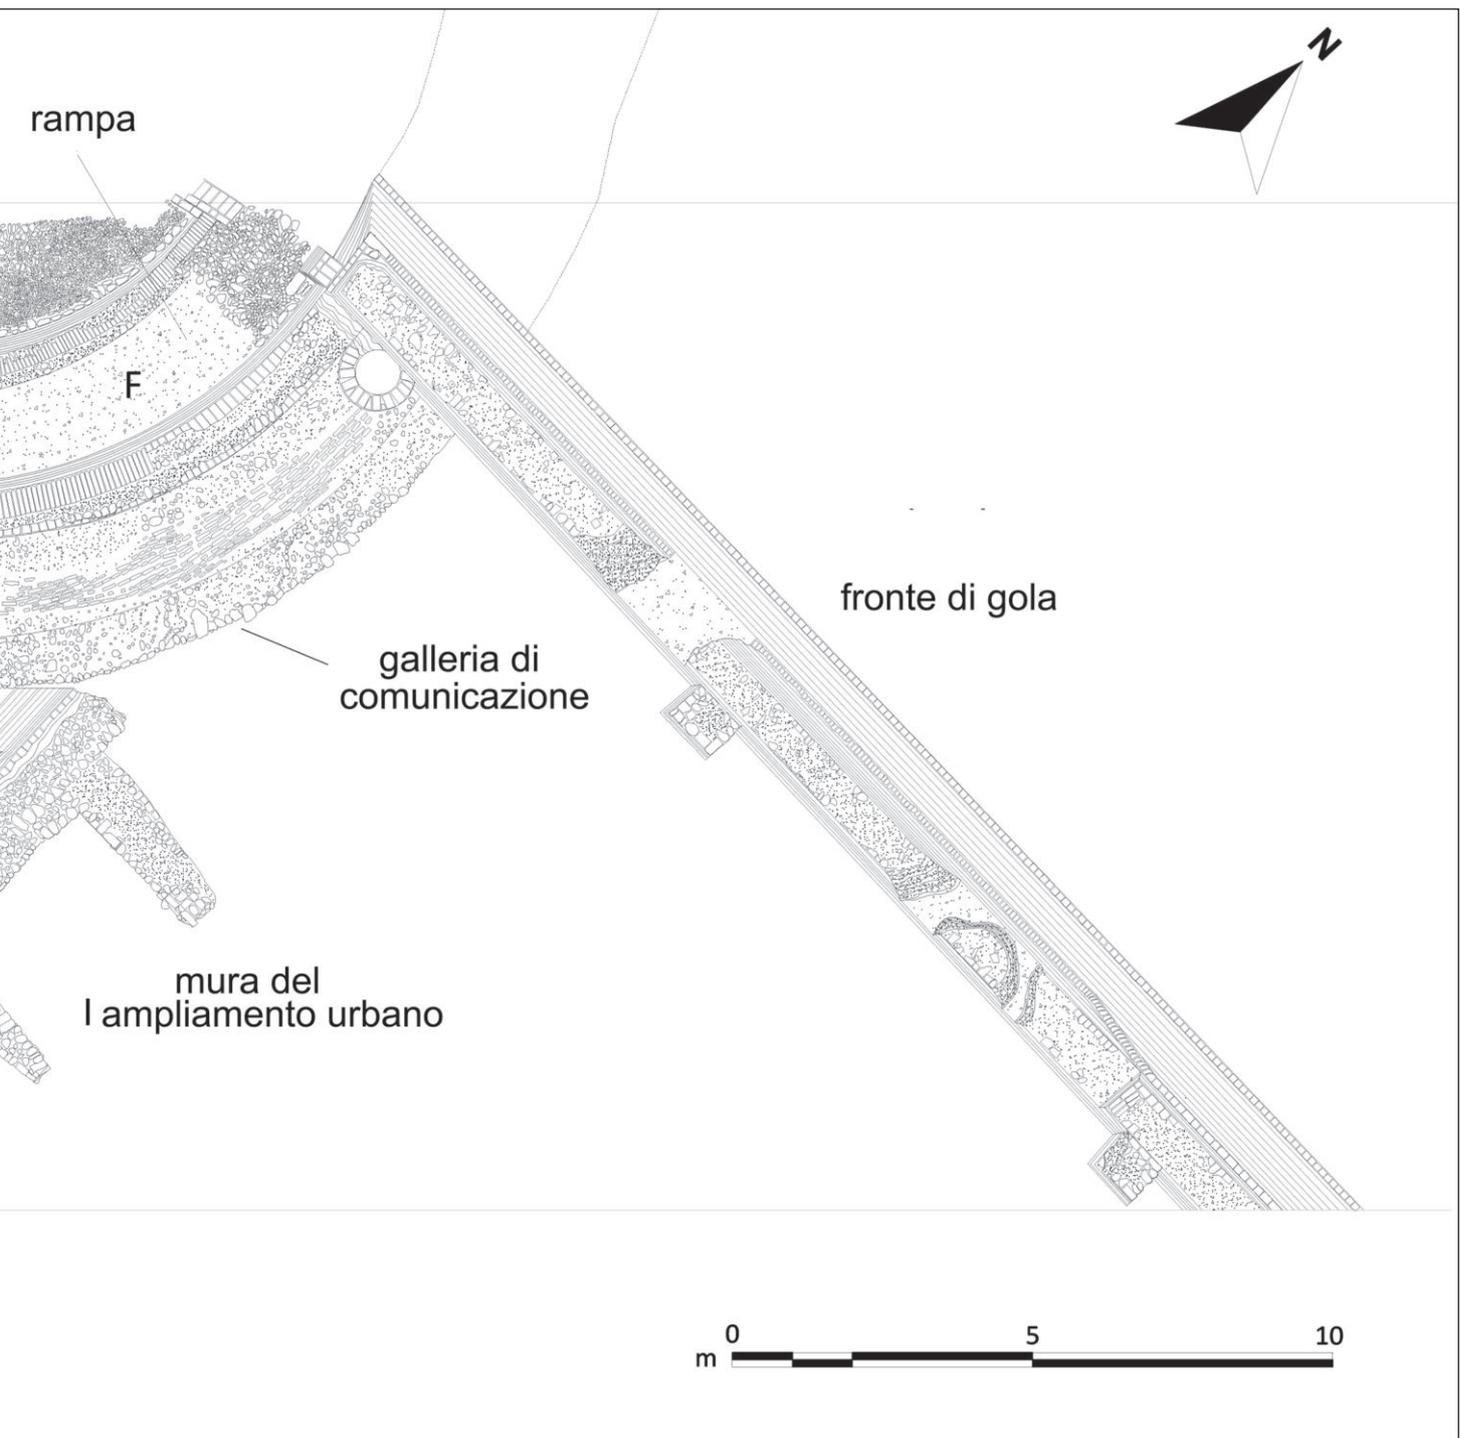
Planimetria del ridotto del rivellino (elab. S. Di Silvestre).
